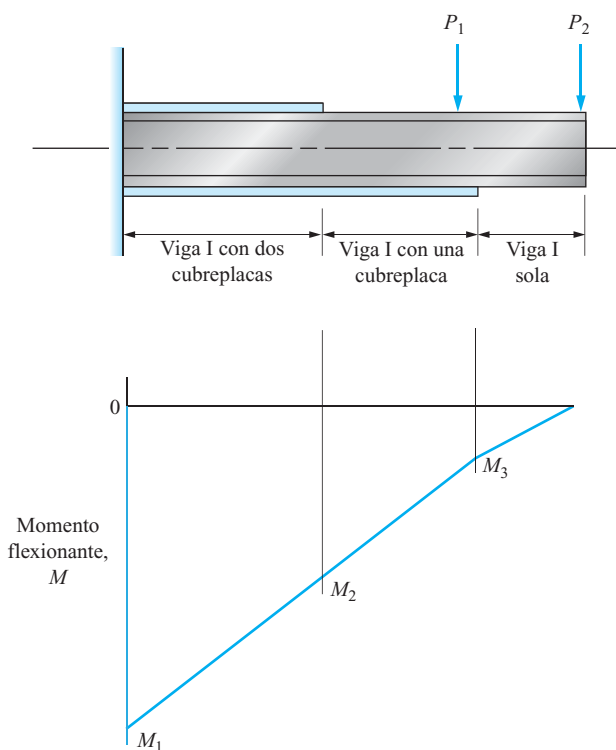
Viga en voladizo con secciones transversales variables.
